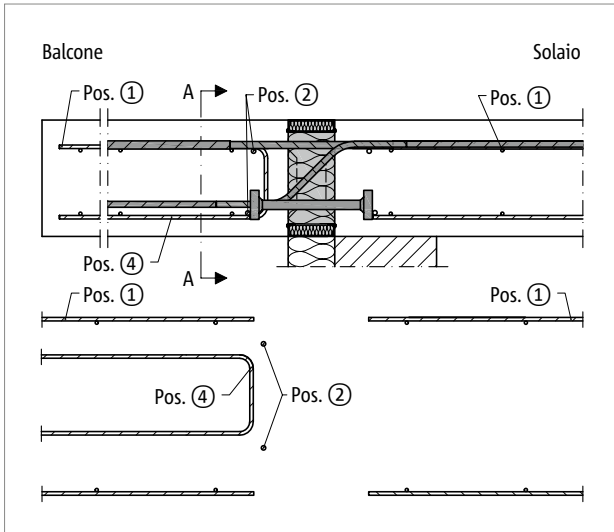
Schöck Isokorb® T tipo K-M12: armatura in opera con appoggio diretto
